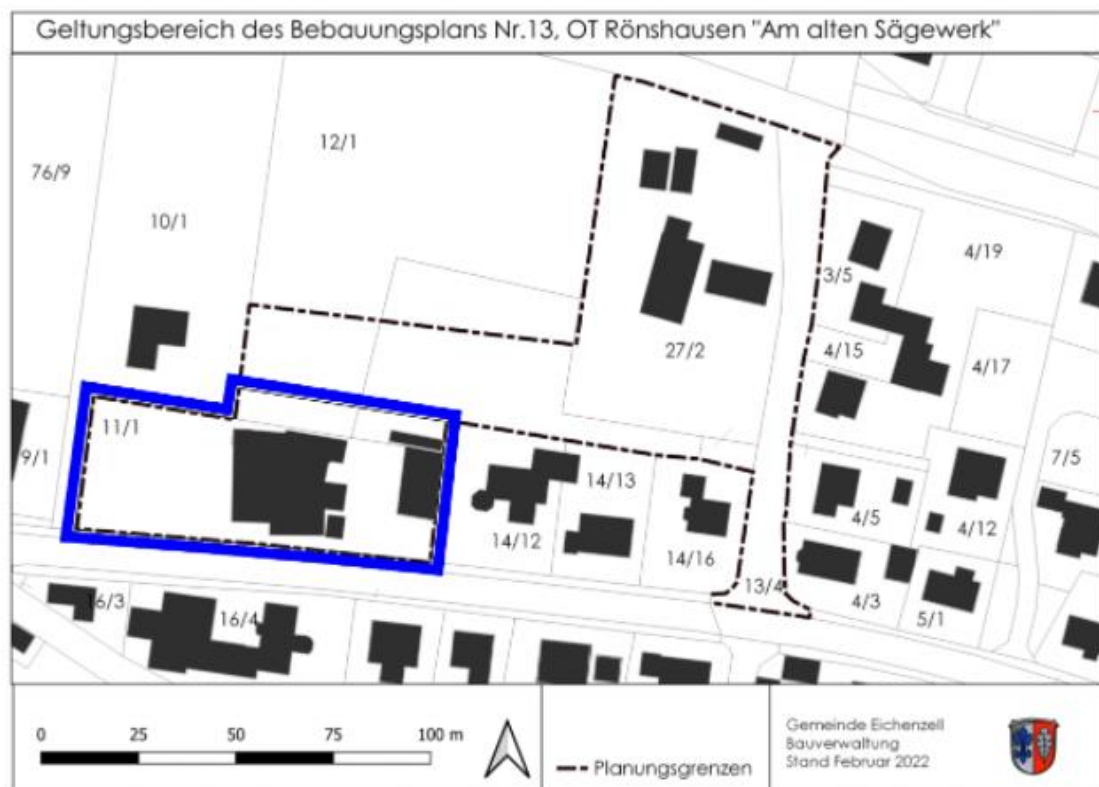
Lageplan mit Geltungsbereich des aktuell geplanten Bebauungsplans (Teilbereich vom BPlan Nr. 13, farblich markiert) mit den dort abzureißenden Gebäuden
